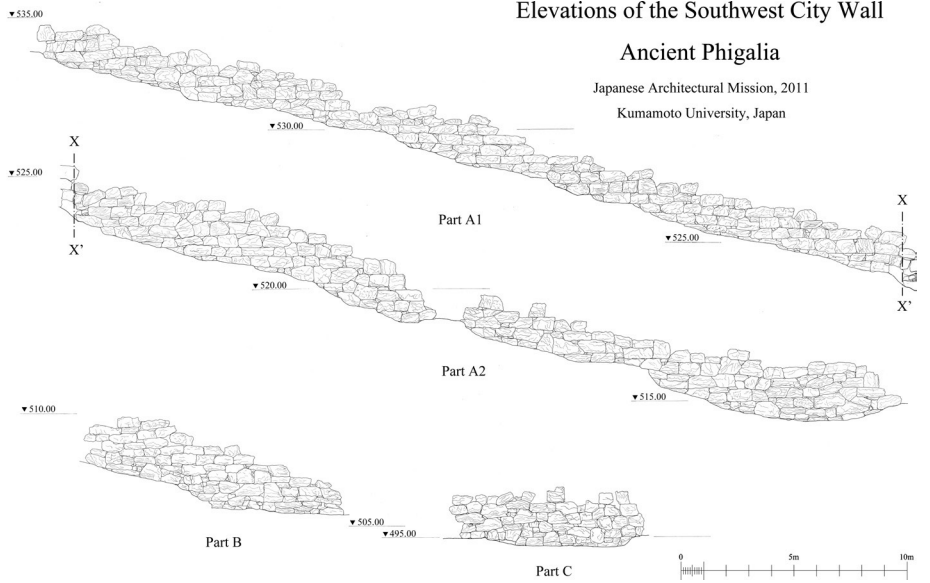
フィガリアの南西部の囲壁のエレヴェーション (熊本大学メッセネ・フィガリア調査隊)
